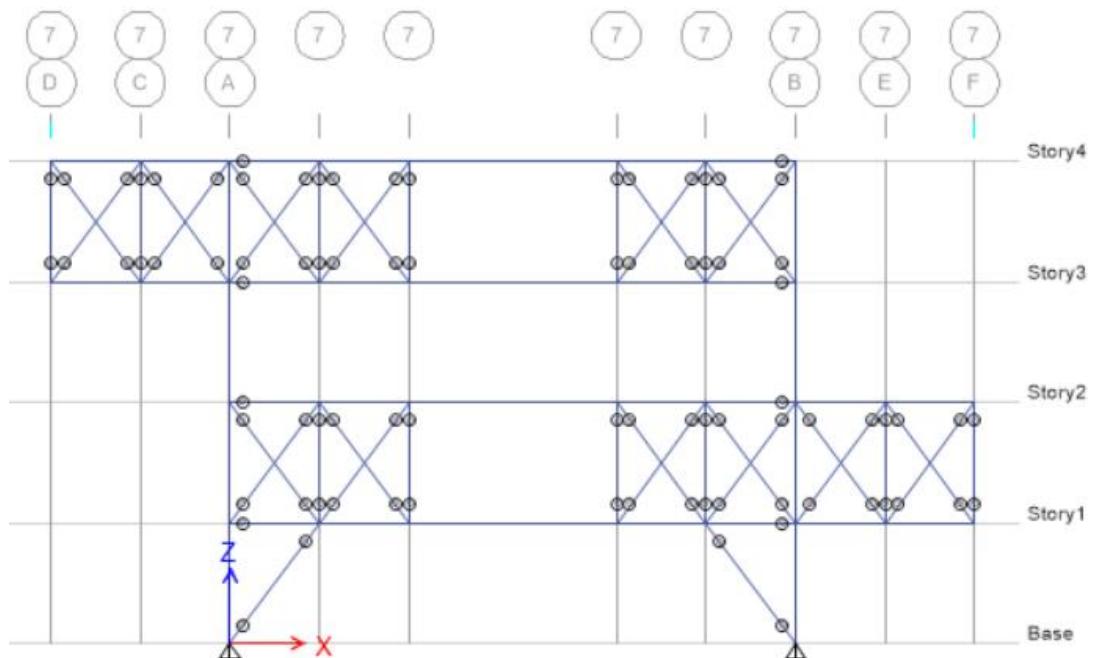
9 Potongan 1-1 dan 7-7 Konfigurasi Pratt Truss
